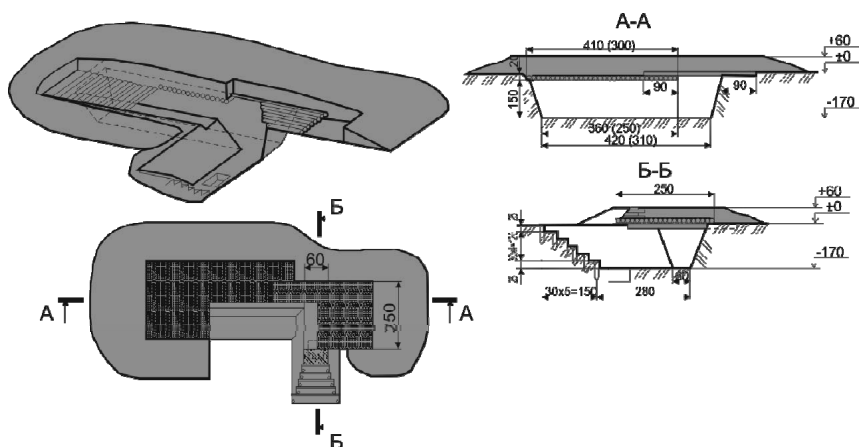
Перекрытая щель на отделение (расчет, экипаж)
